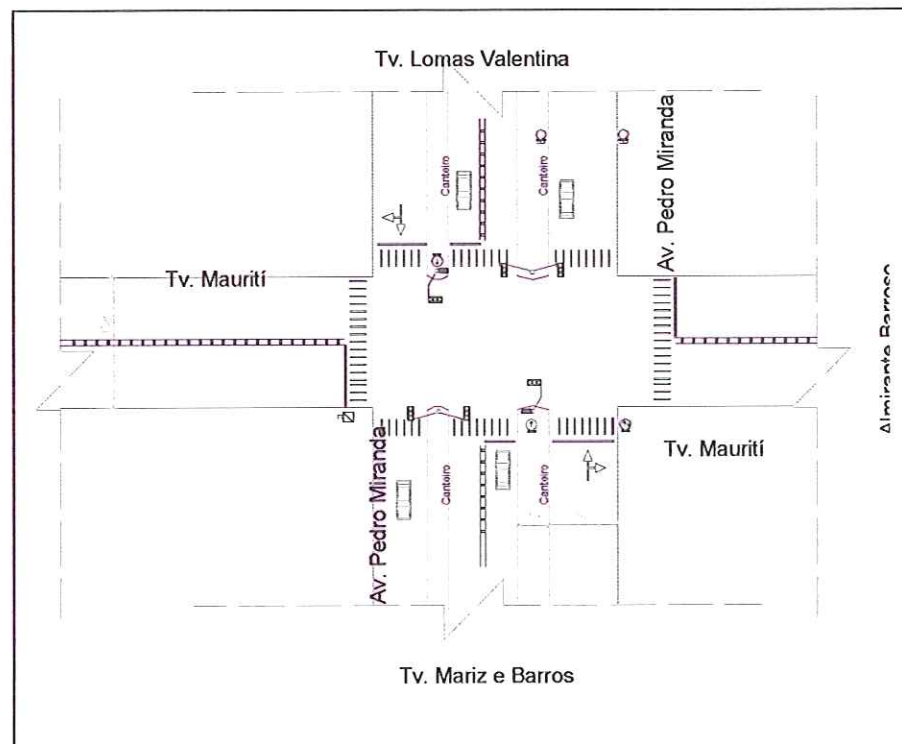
Croqui da interseção da avenida Pedro Miranda com a travessa Mauriti.
